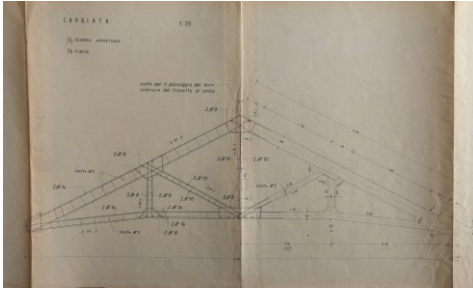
Dettaglio capriata in calcestruzzo armato, restauro castello Piccolomini di Celano (Archivio storico del Genio Civile dell'Aquila, sezione di Avezzano)
